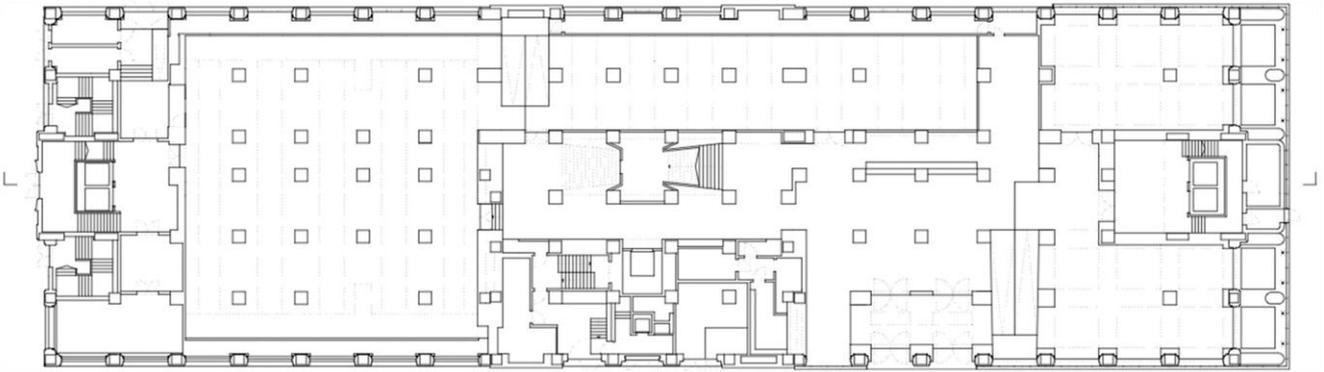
Planta piso 0, 1:500, Museu do Oriente. JLCG Arquitectos
